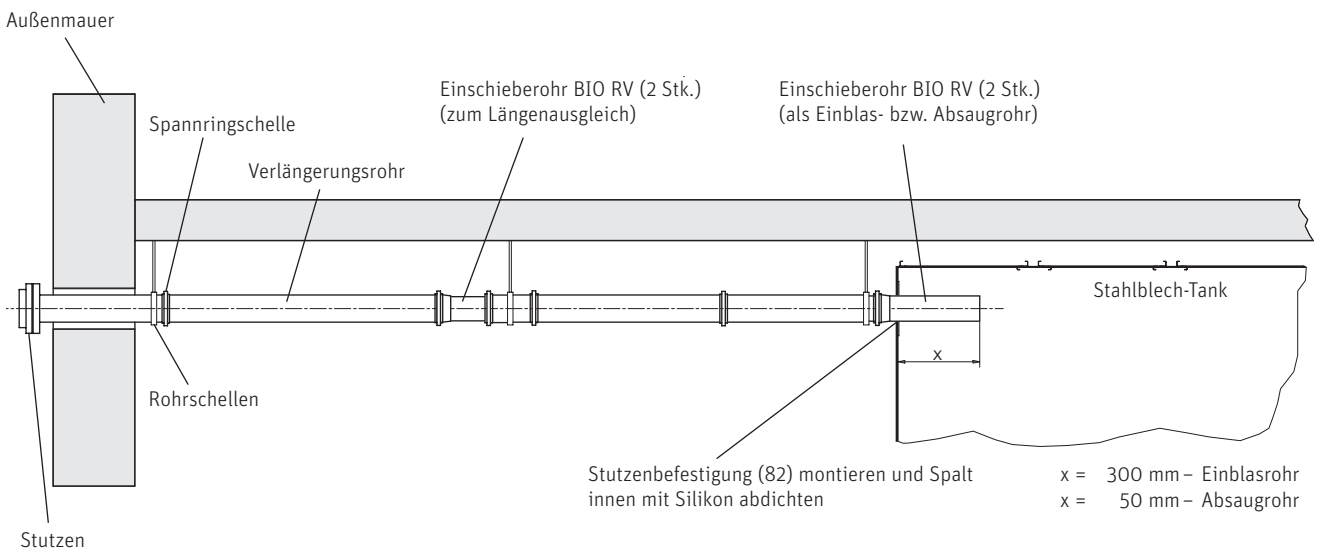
Stutzen mit Verlängerungsrohre und Stahlblech-Tank – Seitenansicht
